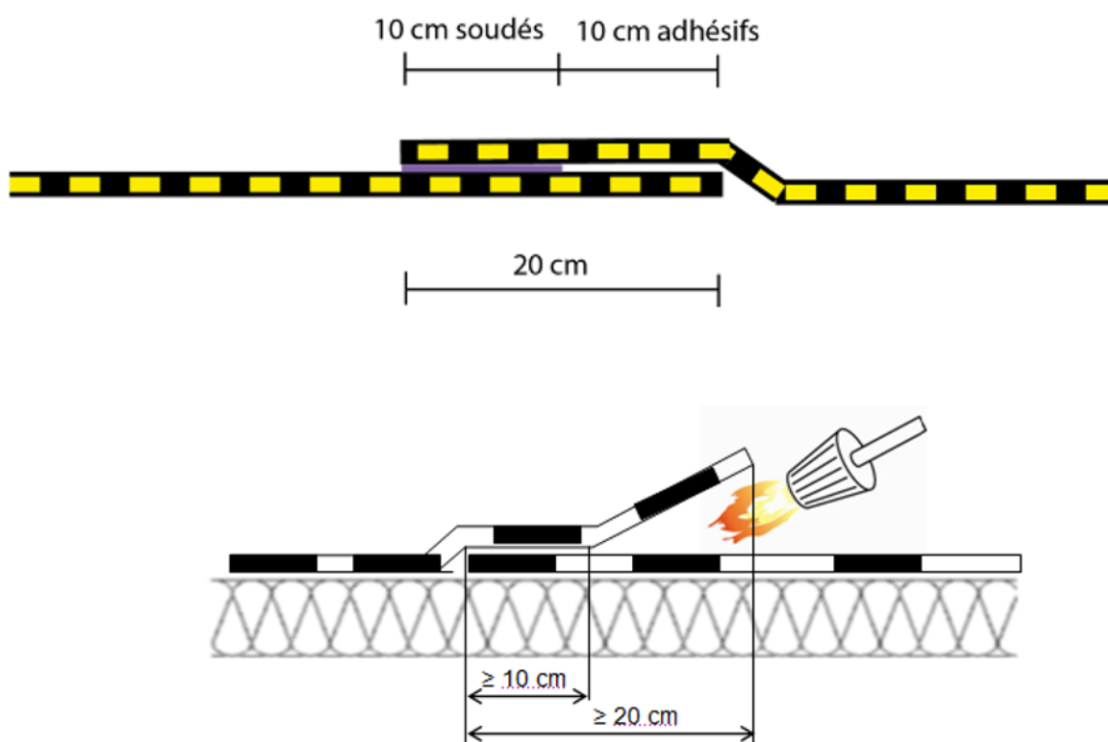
Soudage des recouvrements transversaux des membranes IKO DUO STICK
